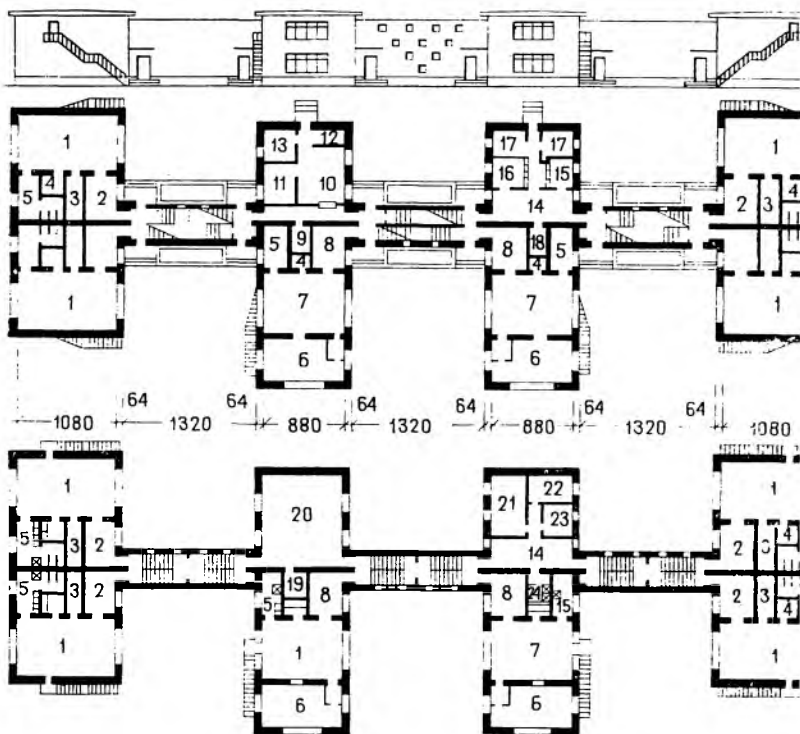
Ташкент. Здание яслей-сада на 280 мест в микрорайоне В-23 жилого района Чиланзар. Фасад и планы первого и второго этажей
